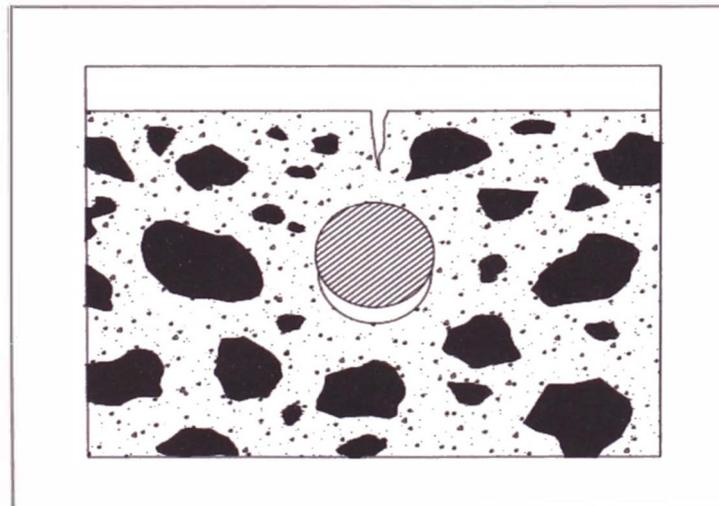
Fisuración por asentamiento plástico del concreto.
